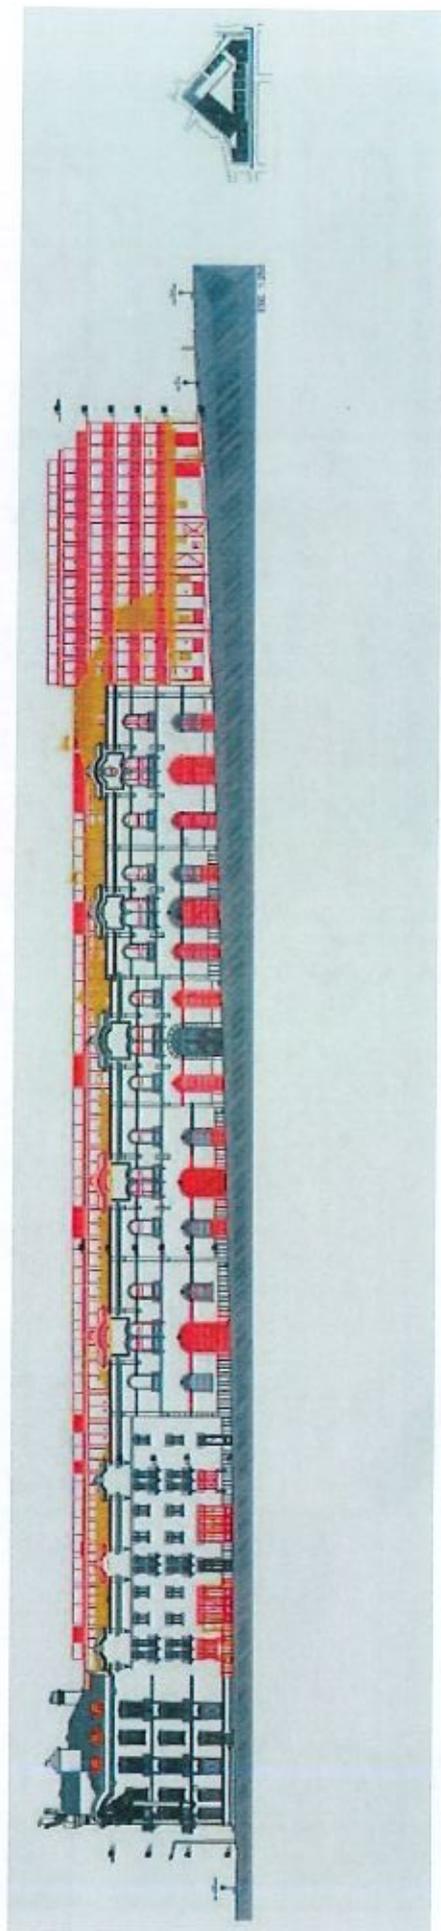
Desenho de Alterações/Cores Convencionais, Projeto de Licenciamento, fevereiro de 2021. Cortes e Alçados 2.01 AE – Alçado nascente, Rua Fernando Palha
